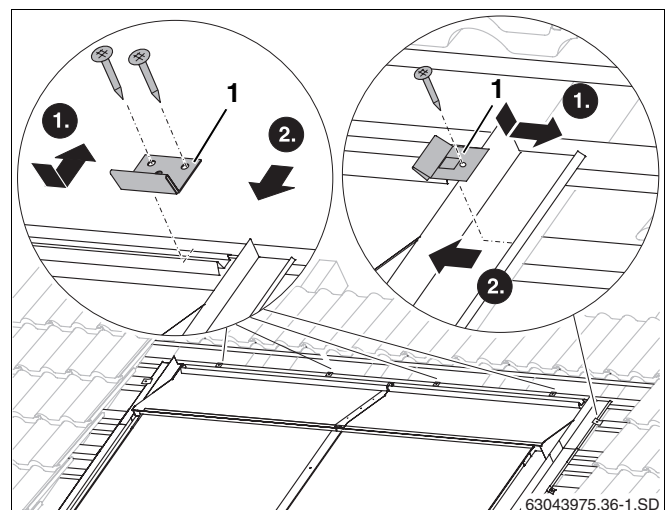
Obere Abdeckbleche mit Haftern befestigen
